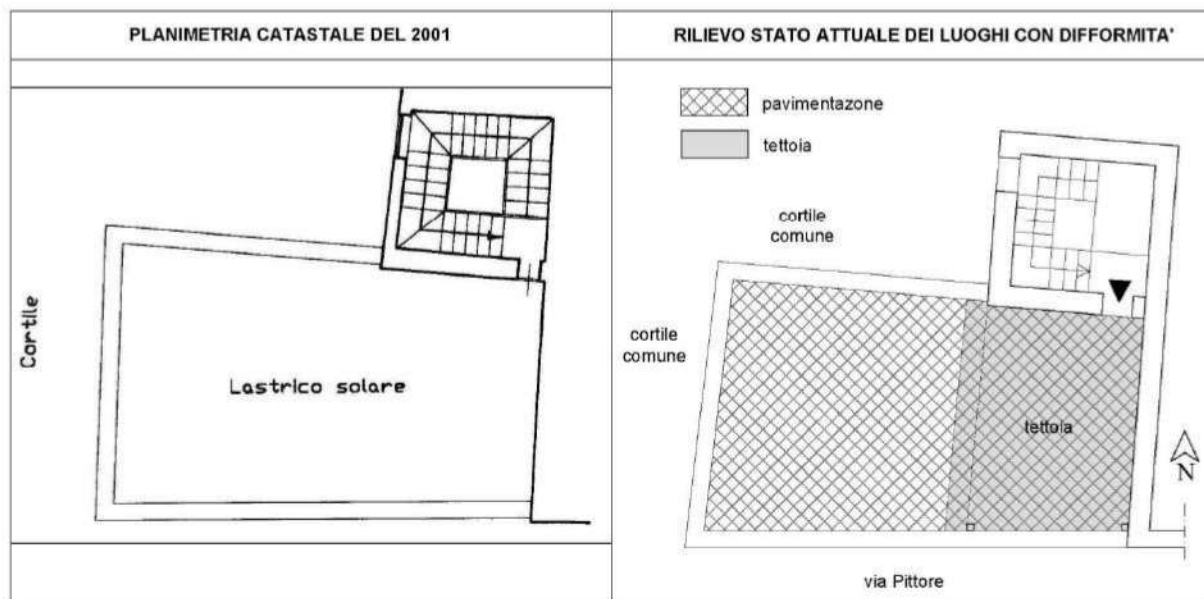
Confronto tra la planimetria catastale del lastrico solare e il rilievo dello stato attuale dei luoghi.
